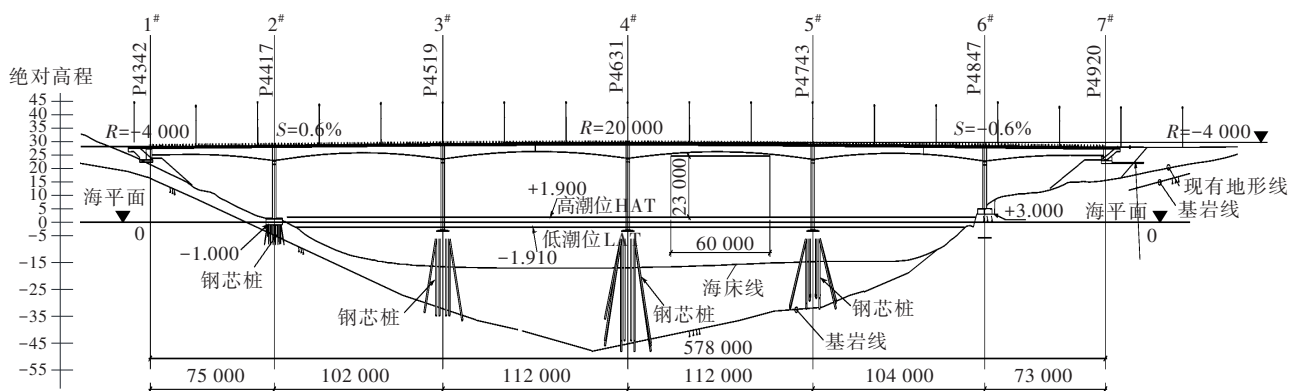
贝特斯塔大桥布置图(除标高为m外,其余单位:mm)
